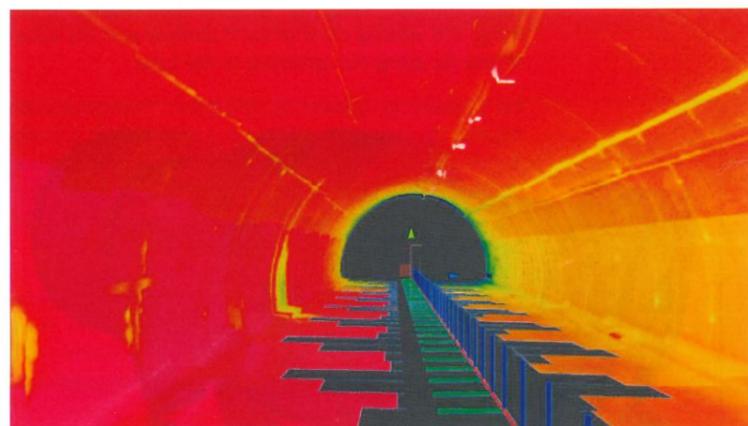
Acquisition infrarouge de l'intrados du tunnel - Infrared survey of the tunnel "intrados" lower surface
